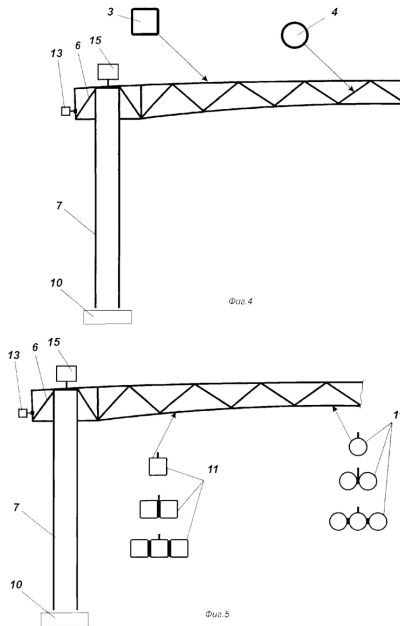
Фиг. 4 - варианты сечений элементов верхнего пояса фермы и раскосов; фиг. 5 - варианты сечений элементов нижнего пояса [3], где: 3 – верхний пояс; 4 – раскосы; 6 – несущие опорные узлы; 7 – колонны; 10 – проектный фундамент; 11 – подвижные элементы нижнего пояса; 13 – лебёдка; 15 – система лебёдок
